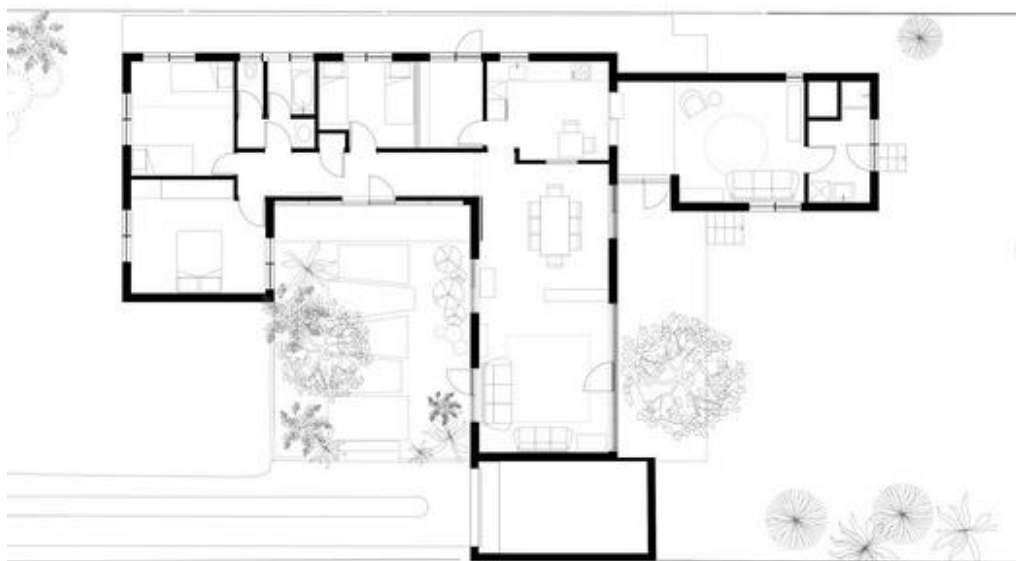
Planta Inicial, Casa PONY. Fonte: Site WOWOWA , Autores: WOWOWA
